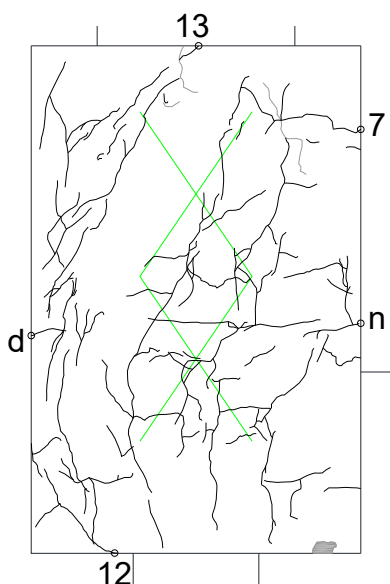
パイルキャップ端部ひび割れ幅測定位置 (試験体 D-4 正載荷)
